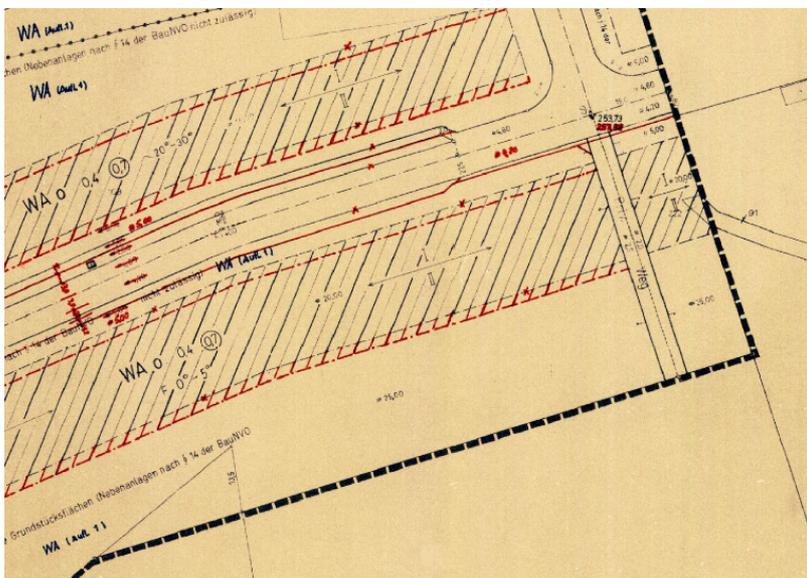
Ausschnitt Bebauungsplan 511 „Paul-Keller-/Kantstraße“
